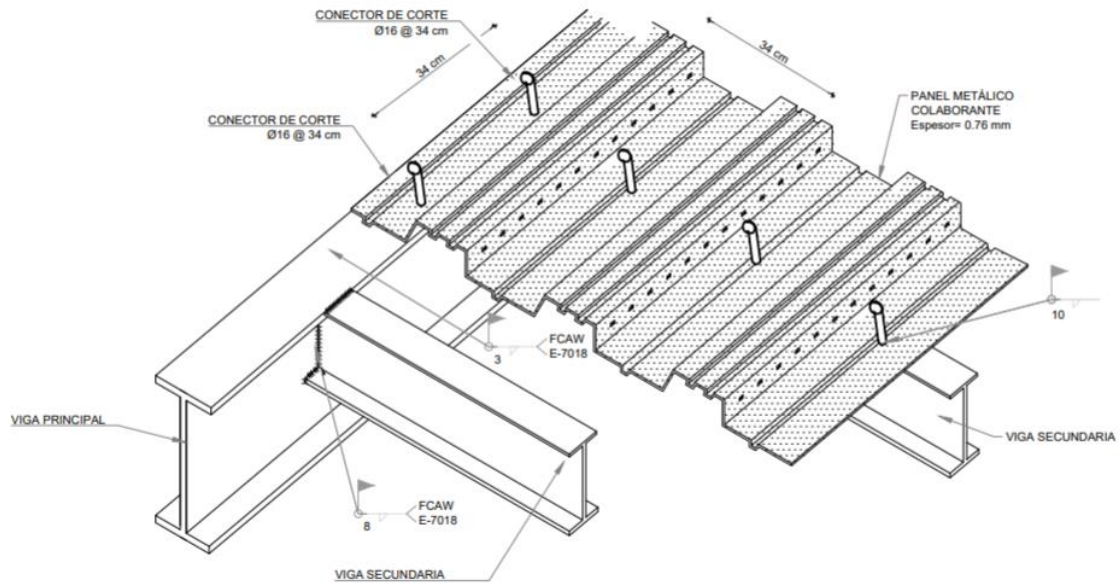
Conexión de vigas al panel colaborante. Elaboración propia, 2019.
